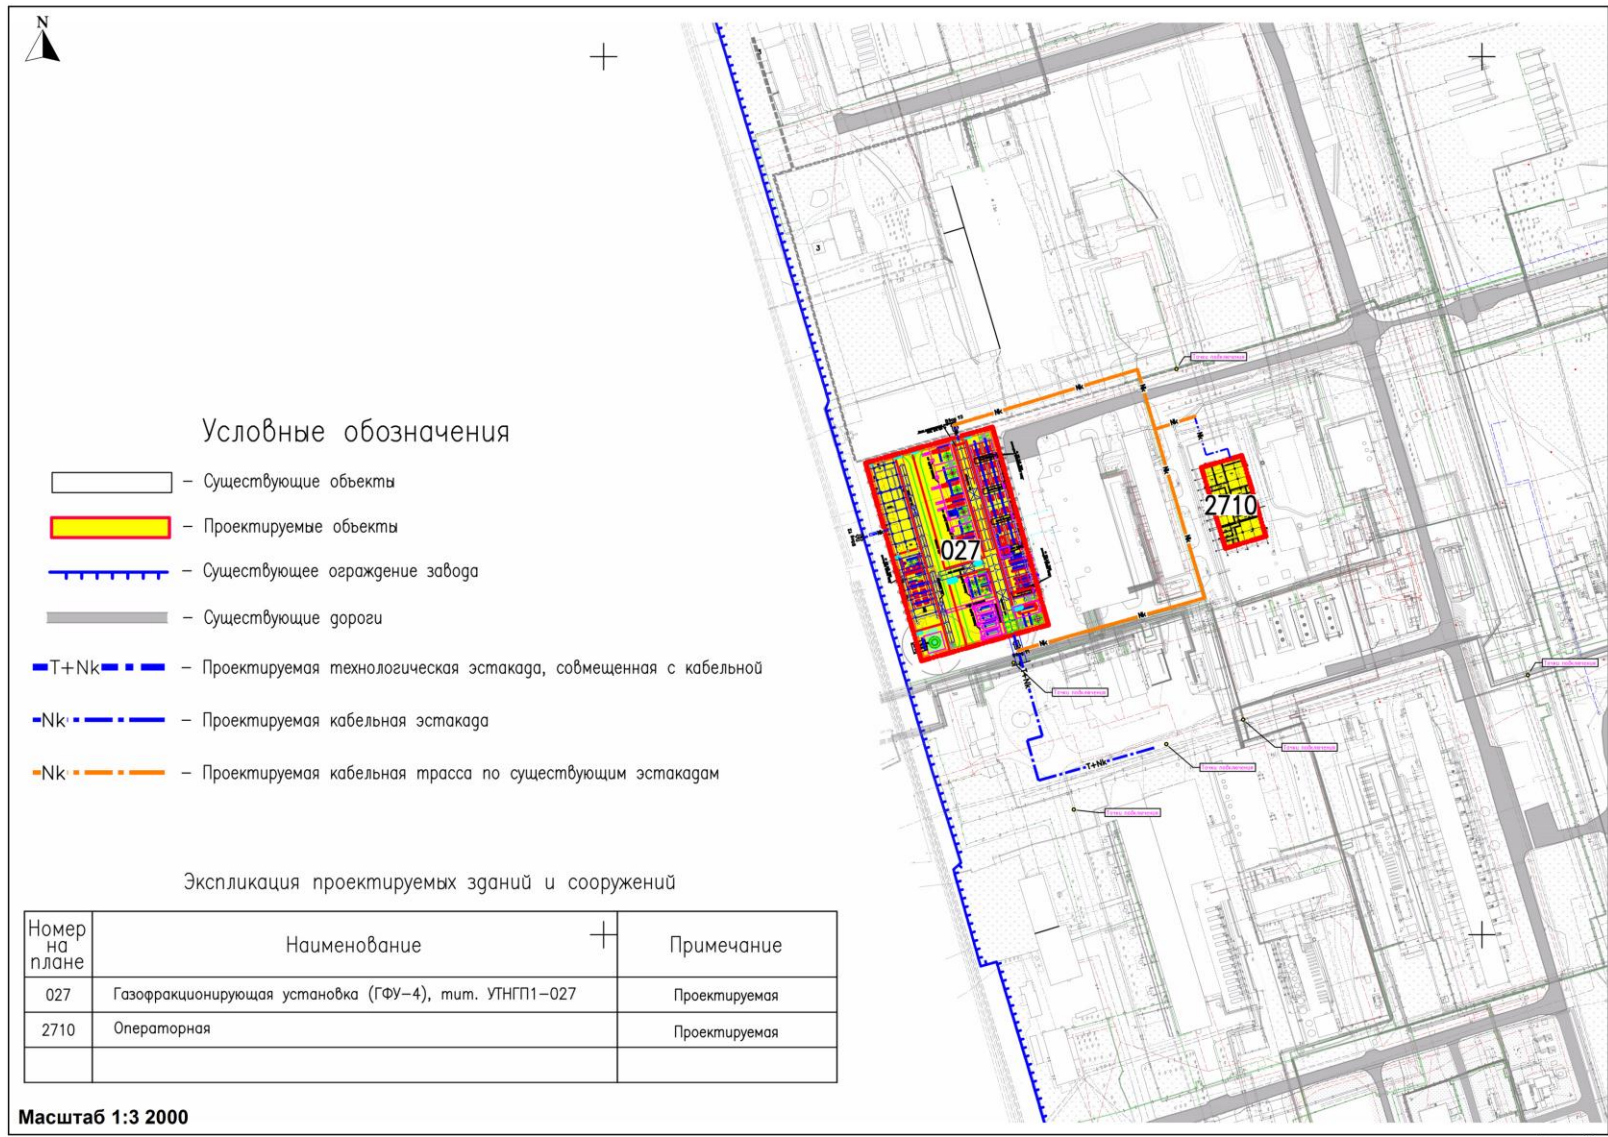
Генеральный план проектируемой ГФУ-4
